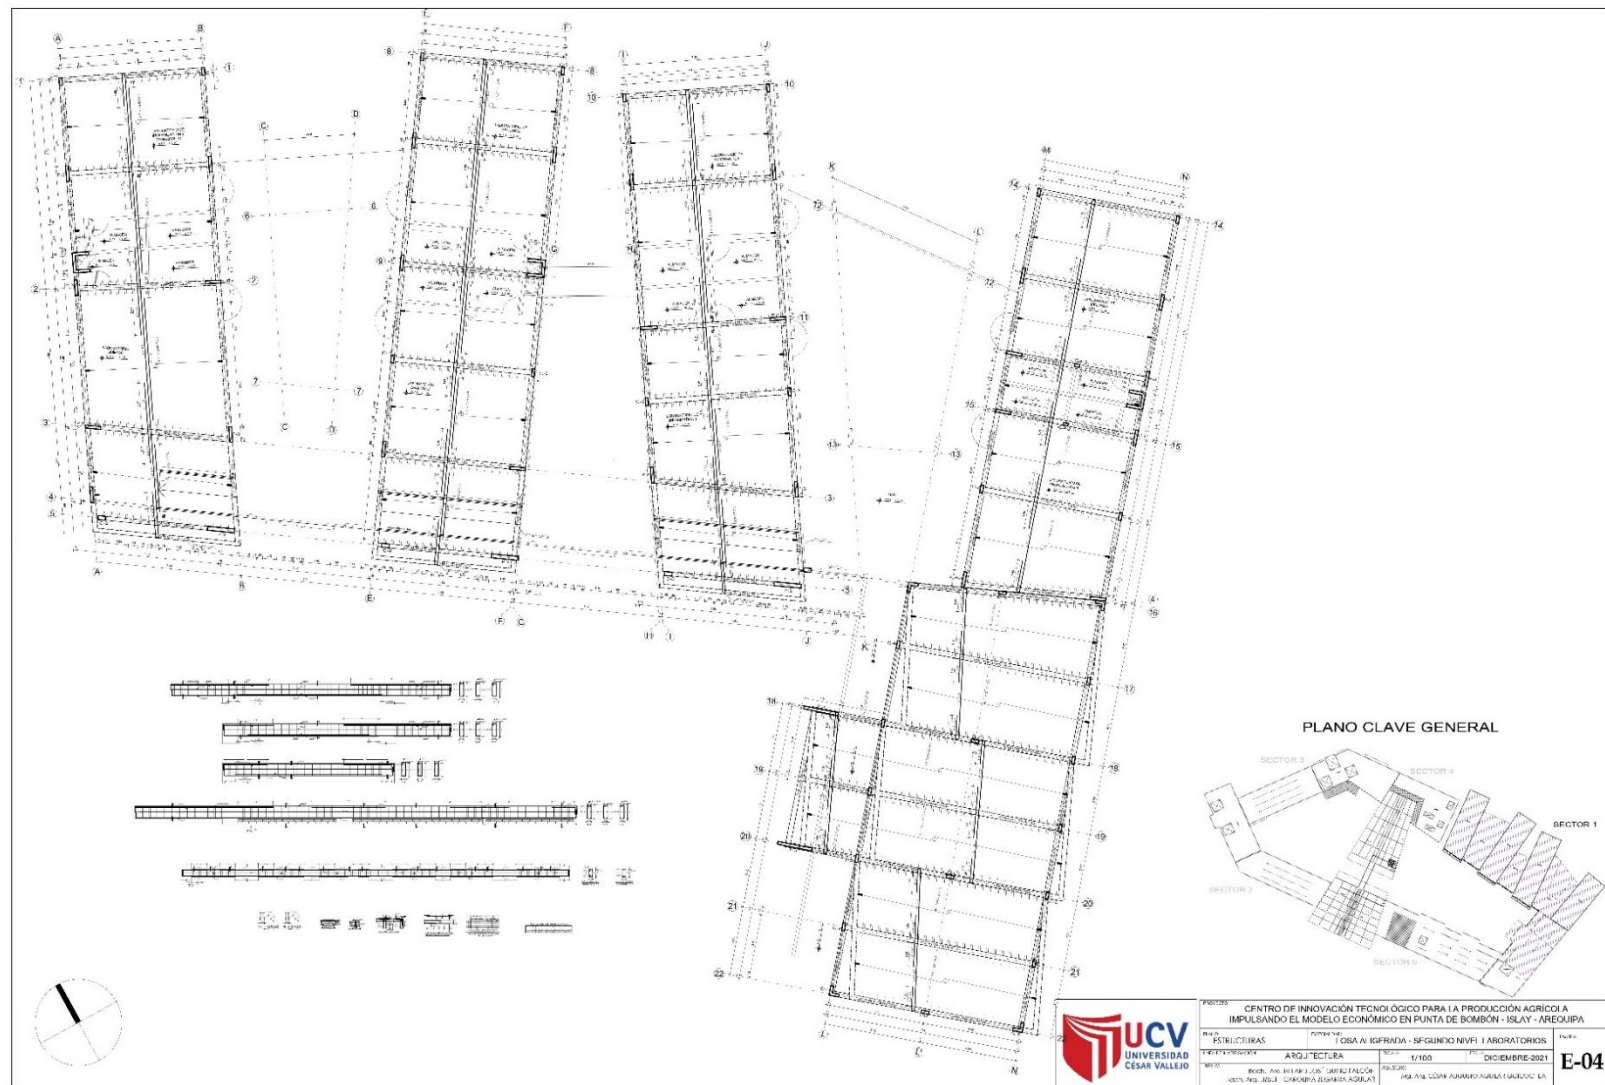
E – 04 Plano de Losa Aligerada de Segundo Nivel - Laboratorios.
